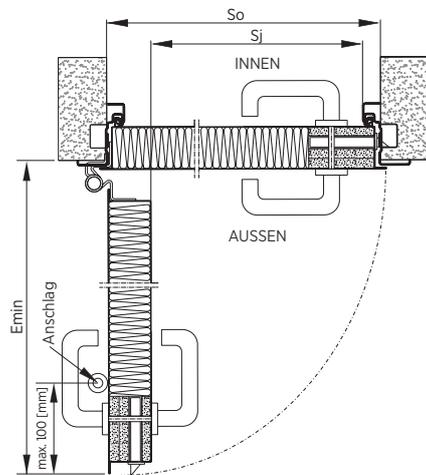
Montage mit Eckzarge - Horizontalschnitt
